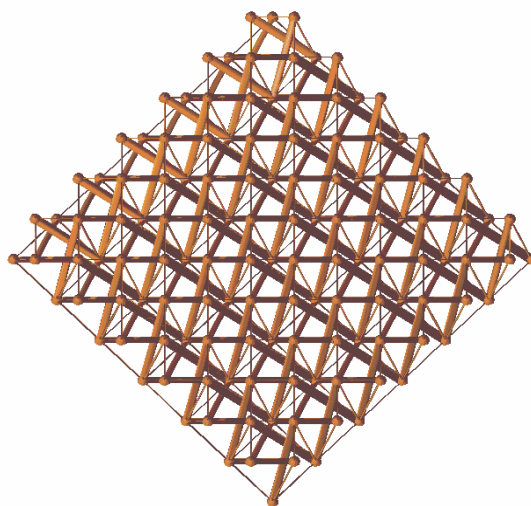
Assemblage sous forme de grille de 36 demi-cuboctaèdres
